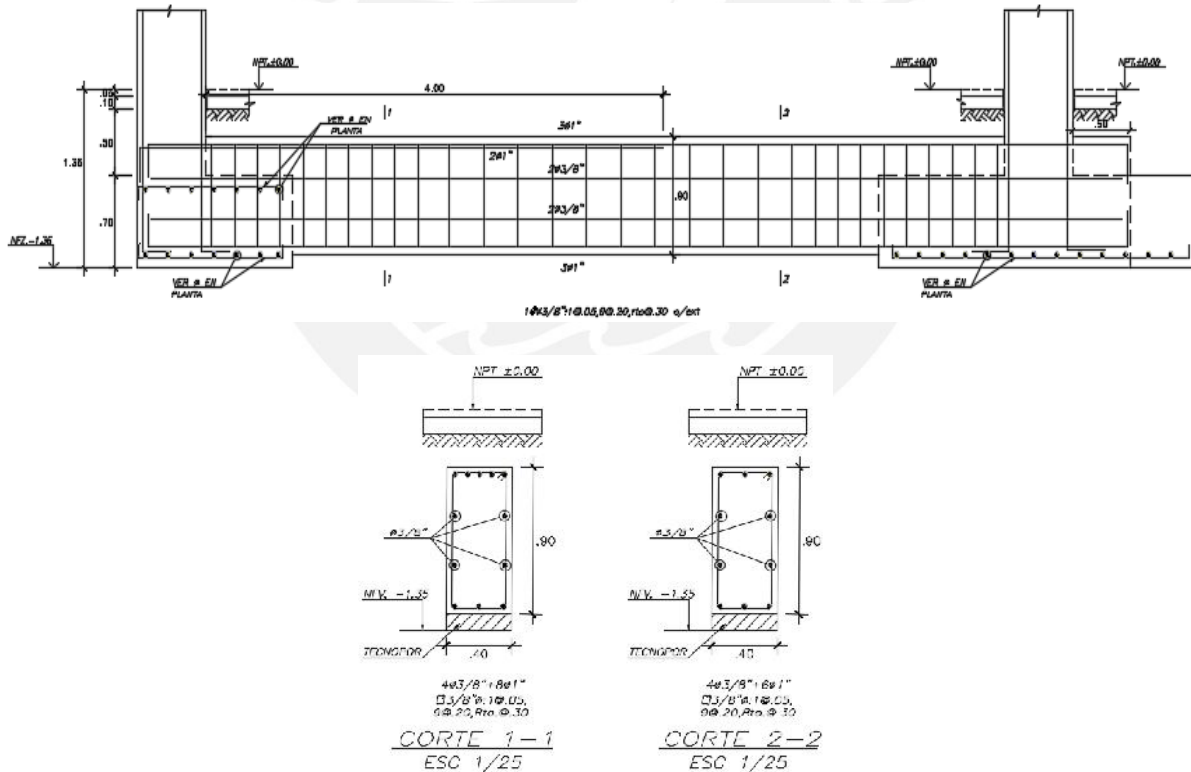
Elevación y sus respectivas secciones de corte de viga de cimentación
